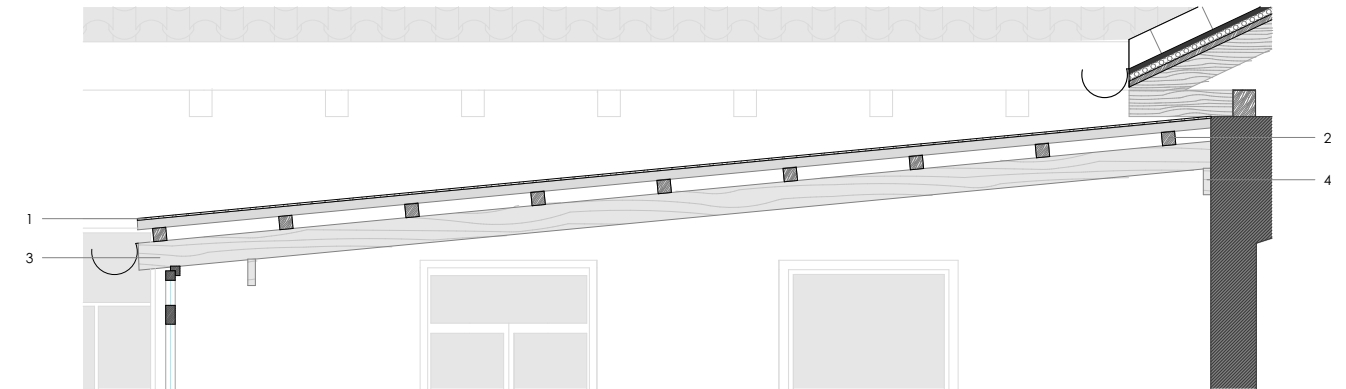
Detalle constructivo 24 | Estado Actual, cubierta sala.
